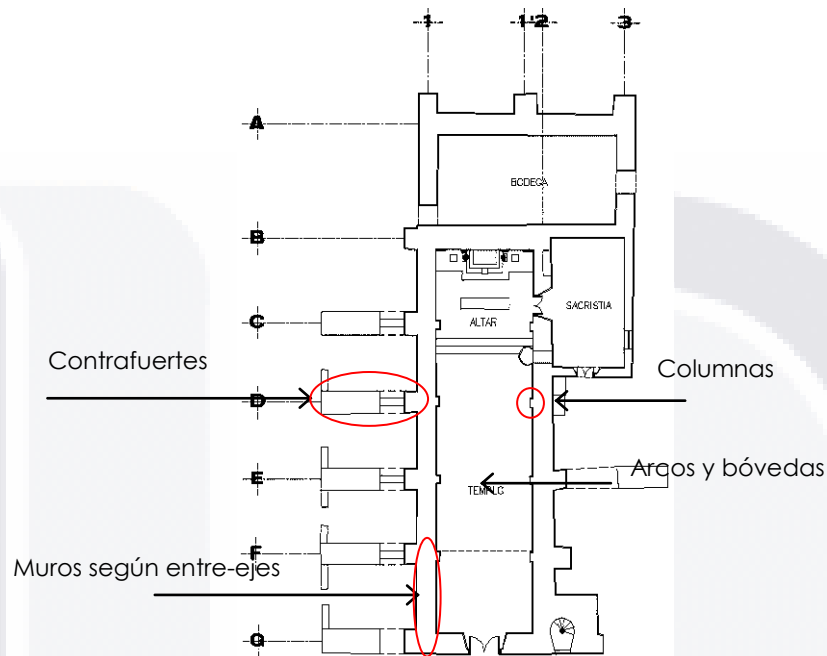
Planta arquitectónica de la Capilla de la trinidad utilizada para la determinación y seccionamiento de las área y elementos estructurales para llevar a cabo el levantamiento de daños.
